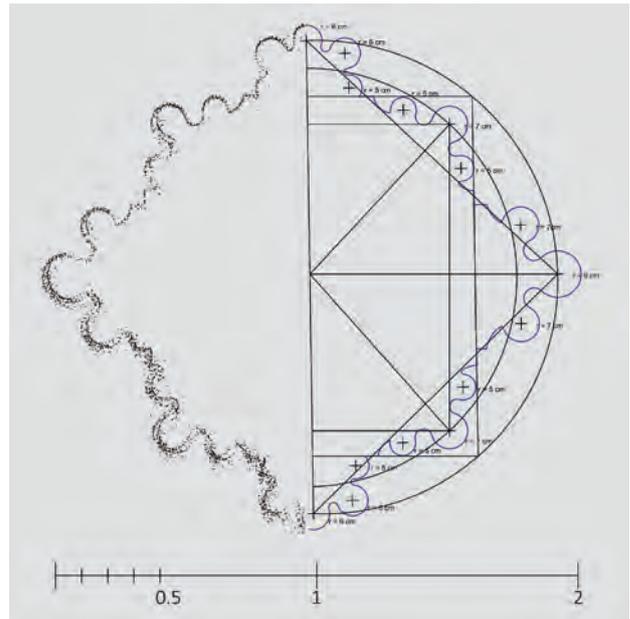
Die unscharfe Punktwolke eines Pfeilergrundrisses des terrestrischen Laserscanners wird bauteilgerecht nachkonstruiert und so selbst zum Träger erweiterter Informationen [Nöbauer / Salzer 2020].
